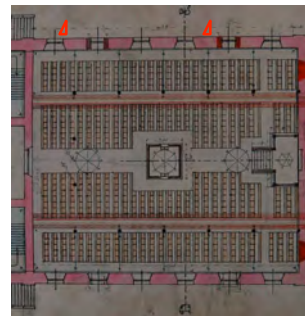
Grundriss Ausschnitt mit zwei eingezeichneten Türen, einmal links und rechts in der oberen Außenwand
